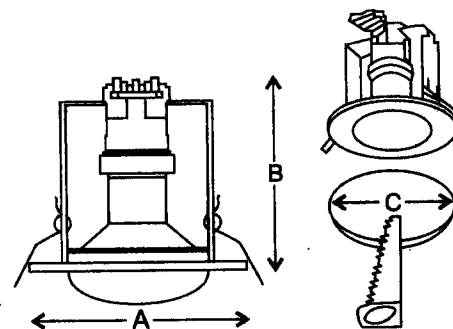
Типовая конструкция точечного неповоротного светильника под лампу накаливания: А — внешний диаметр светильника; В — глубина всей его установки; С — диаметр посадочного отверстия
